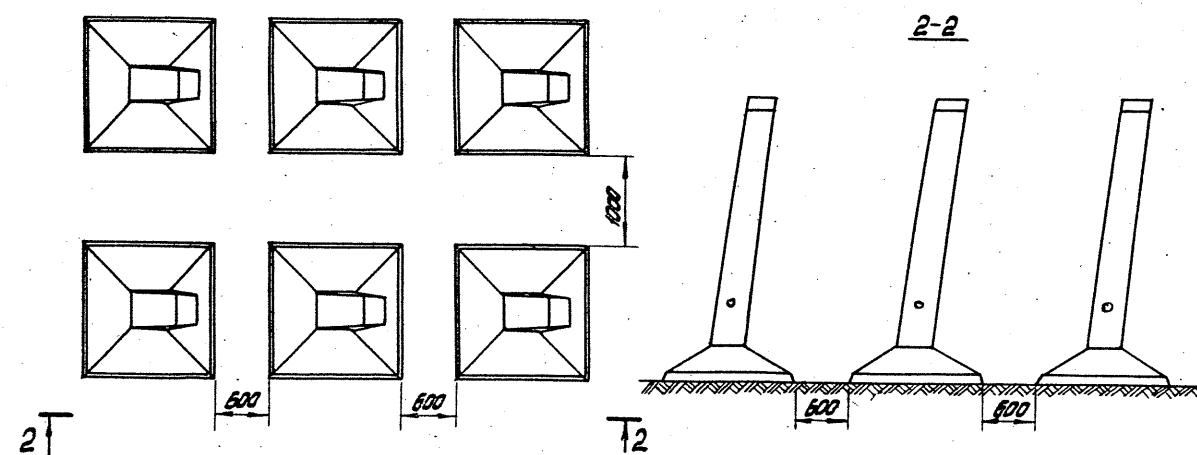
Схемы обвязки фундаментов анкерно-угловых опор
